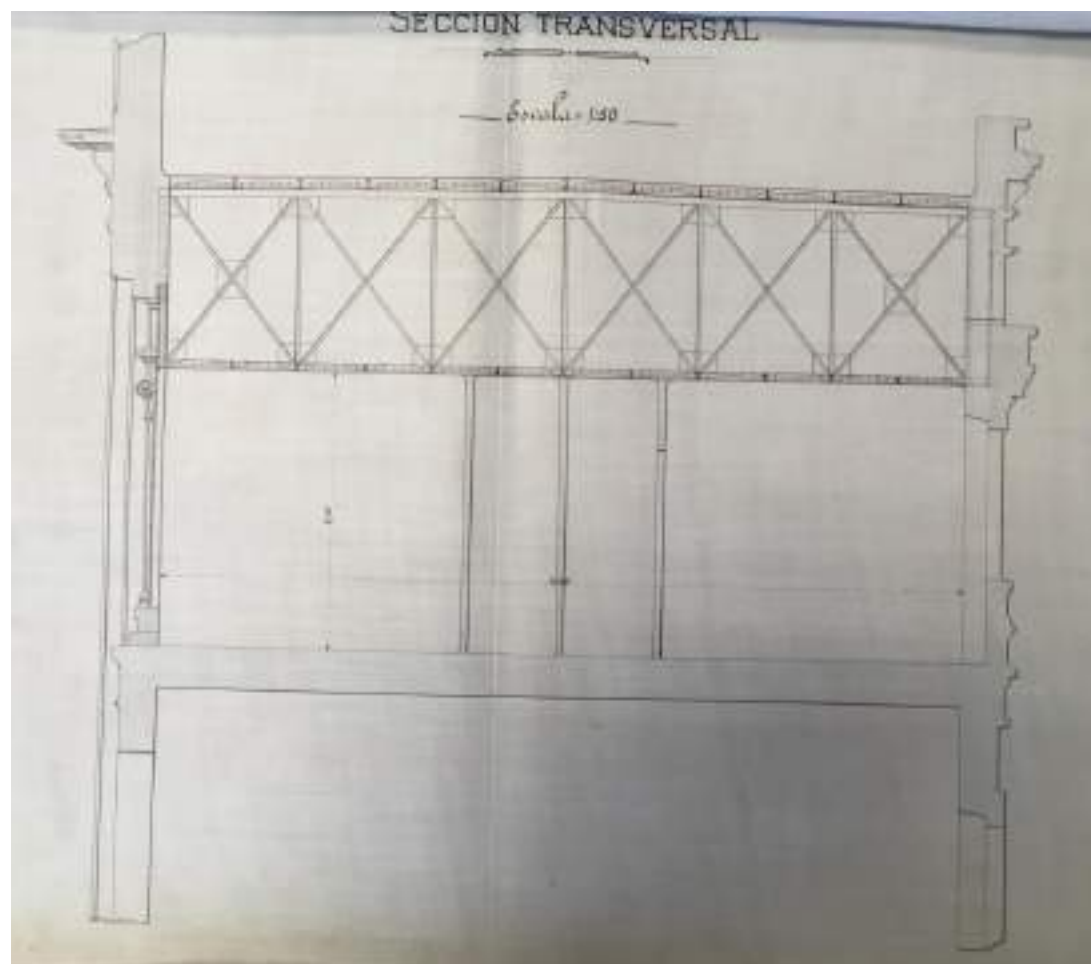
Sección transversal Vigas para la cubierta del pabellón central (Escala 1:50), 1907, "Proyecto de entramado metálico para la cubierta del Pabellón Central del Edificio de Viajeros". AHF-MFM. signatura B-0057-006 6/16.
